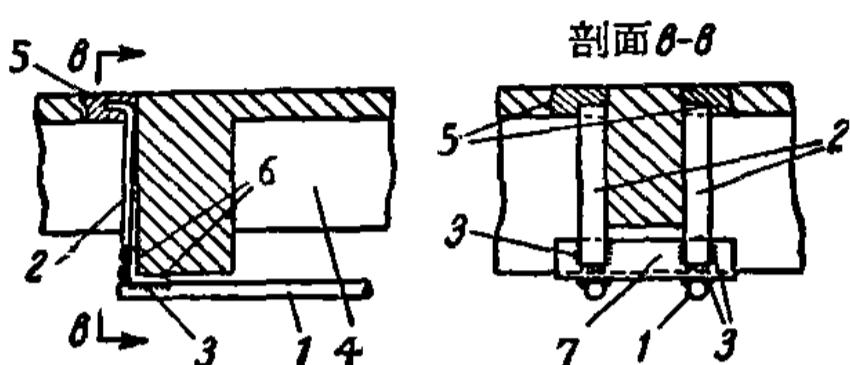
钢筋混凝土构件中间支座上水平补强拉杆的锚固装置结构
